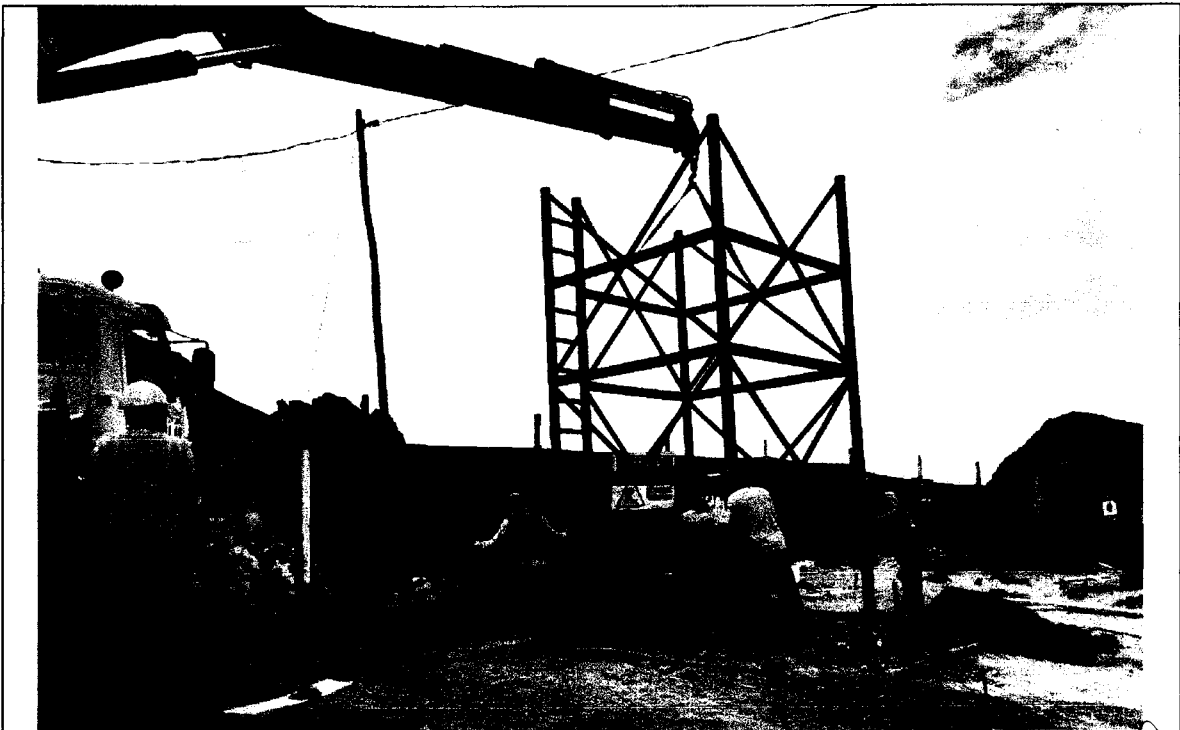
IZAJE DE LA ESTRUCTURA DE ACERO QUE SOPORTARA EL TANQUE ELEVADO.
